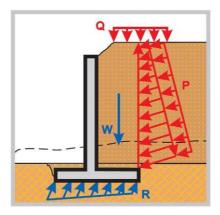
Fonctionnement d'un mur en en béton encastré sur semelle; P: poussée des terres du massif soutenu; W: poids des terres à l'aplomb de la semelle ;
